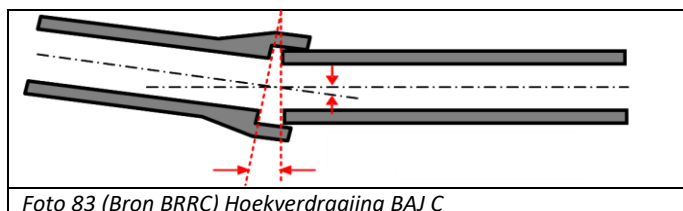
(Bron BRRC) Hoekverdraaiing BAJ C
